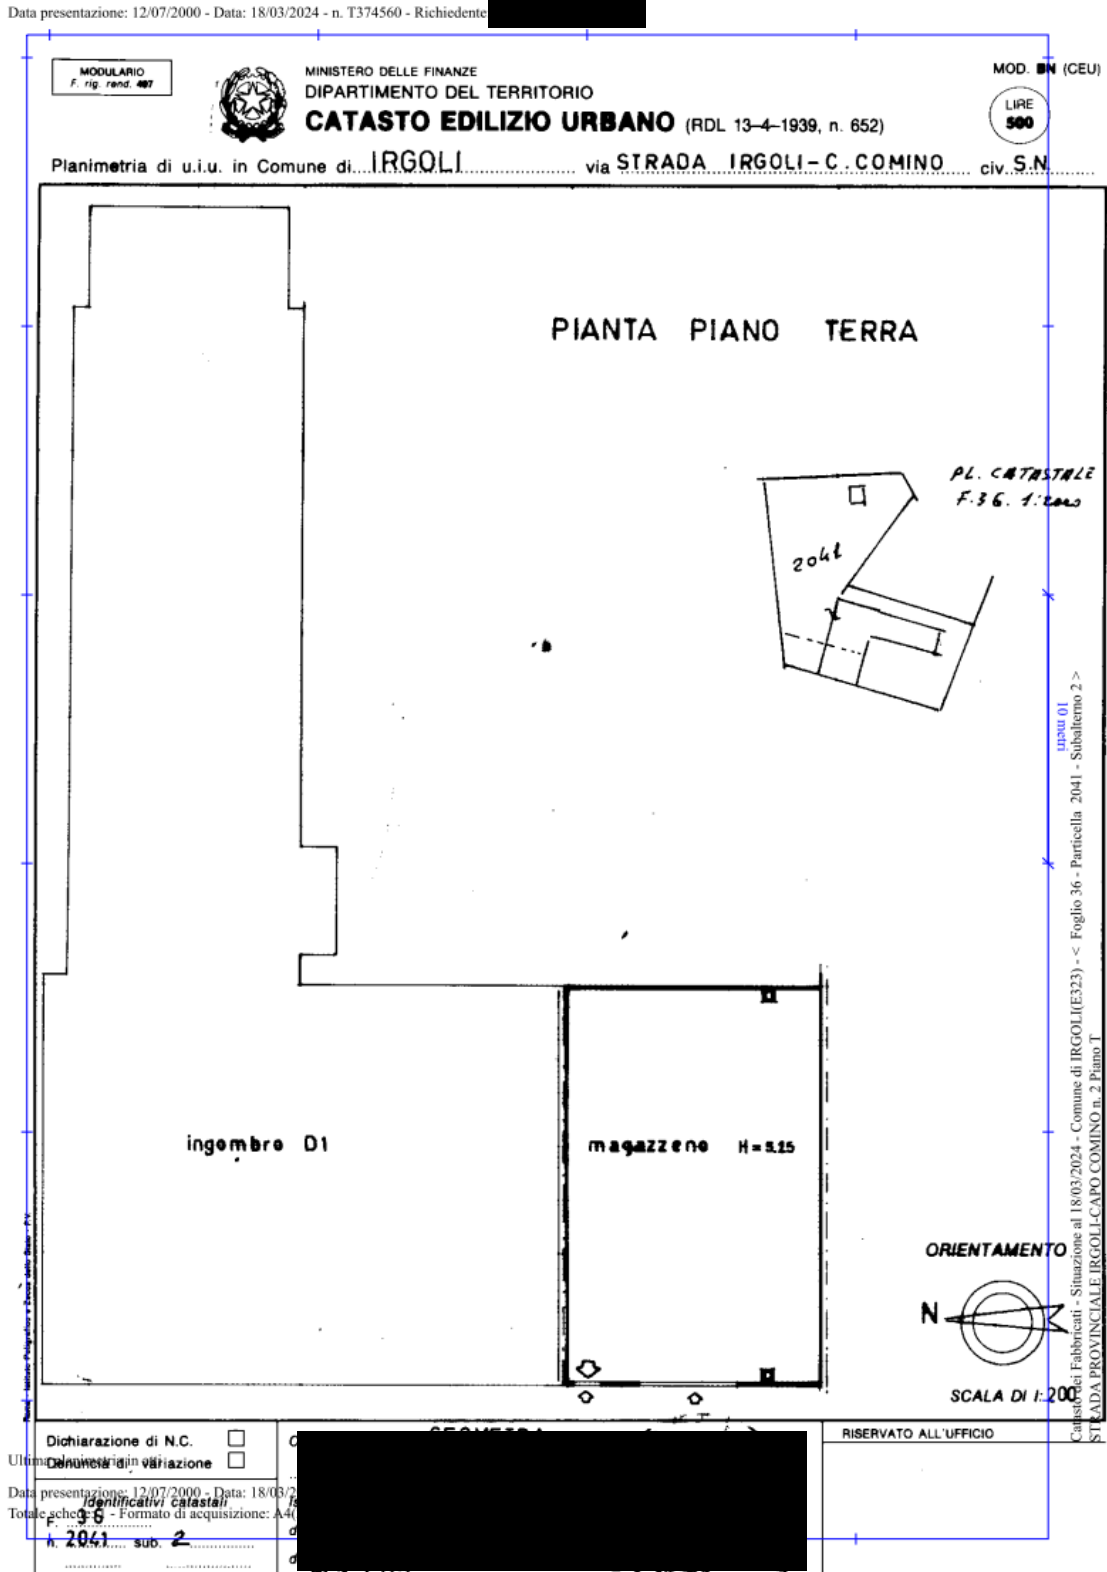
\_Planimetria al foglio 36 p.lla 2041 sub 2\_locale magazzino
